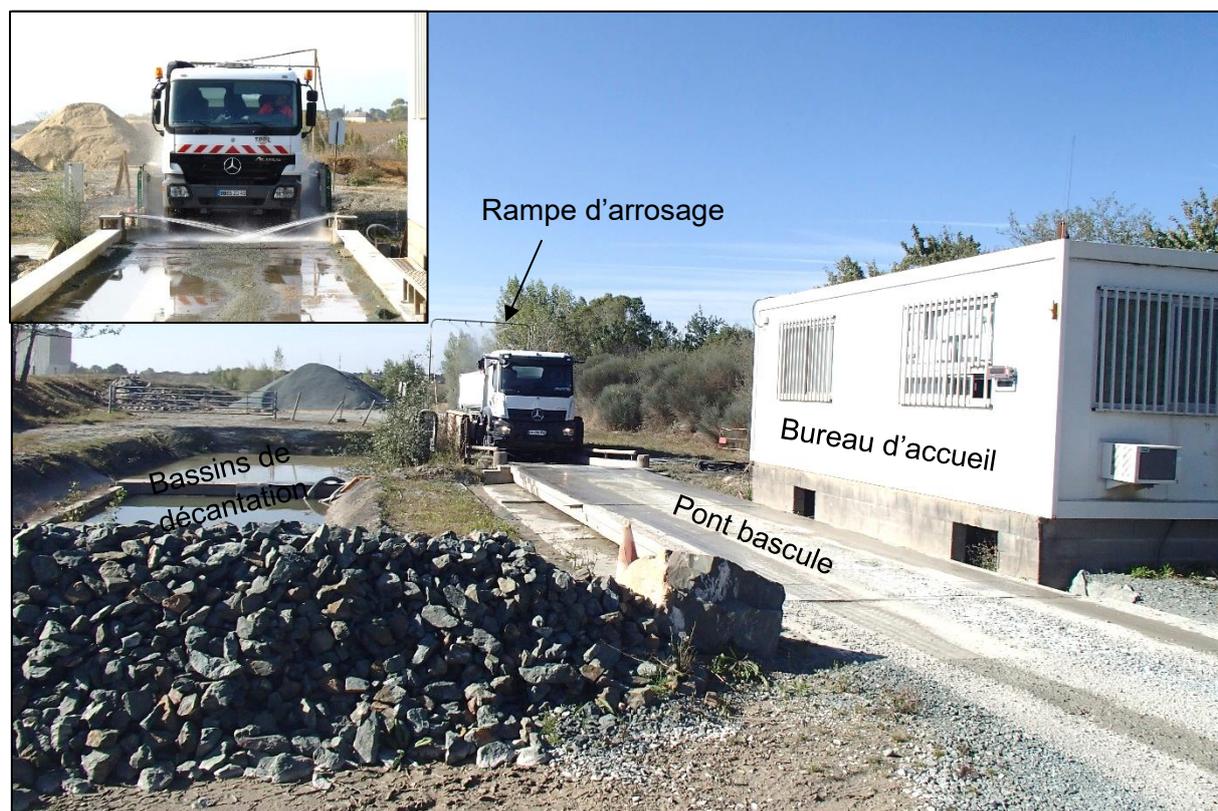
La bascule actuelle et rampe d'arrosage/dispositif lave-roues en place
